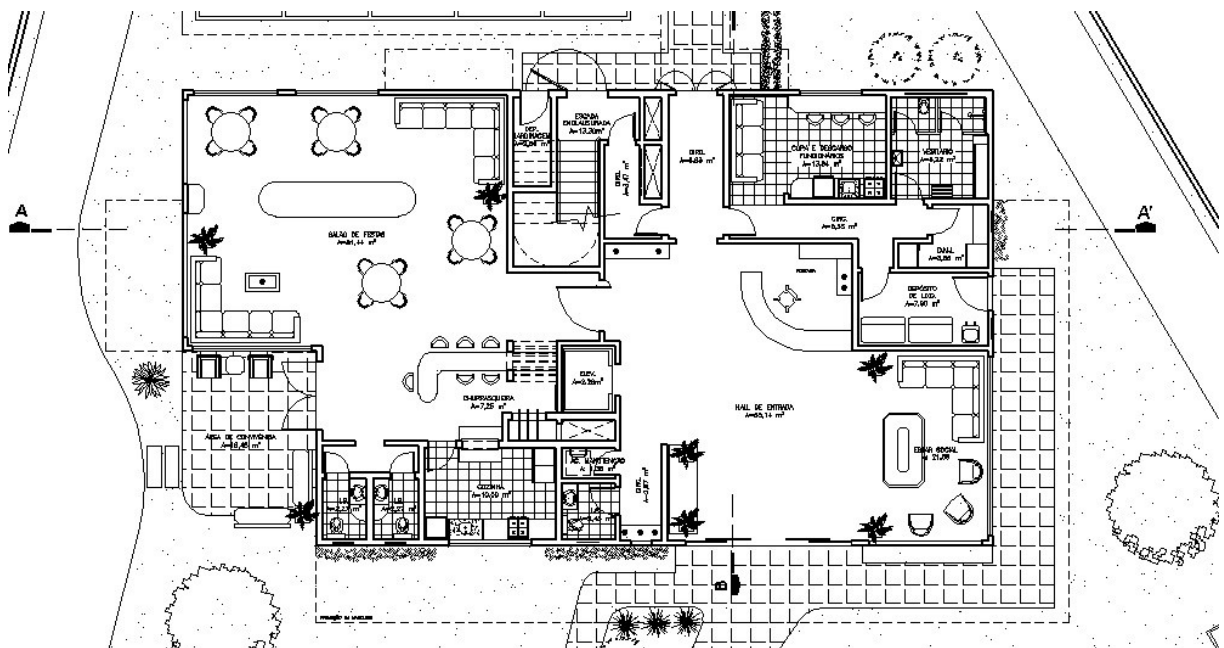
Planta do Pavimento Térreo do objeto de estudo global
